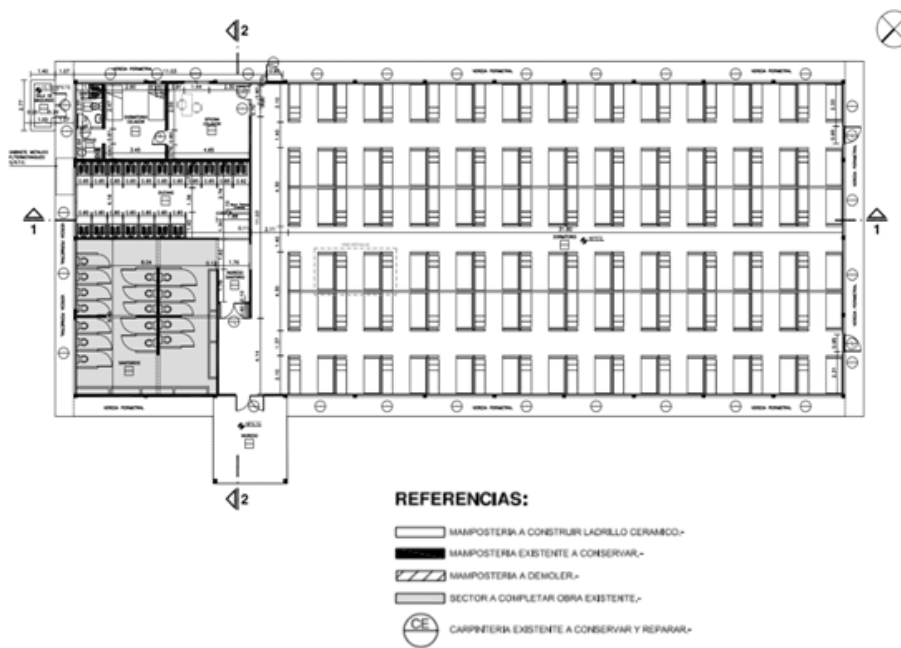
Planta de Compañías en edificio de Ex Lavadero.
